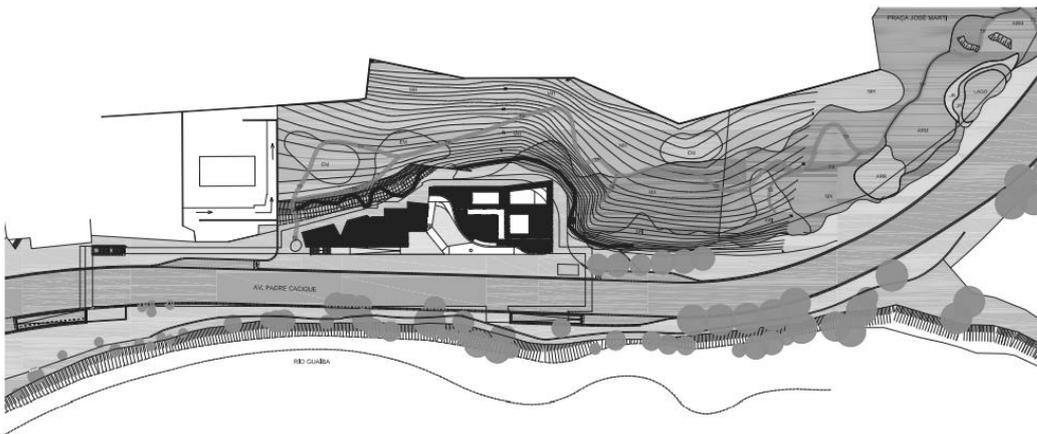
Planta de situação - Fundação Iberê Camargo, 1998-2008
